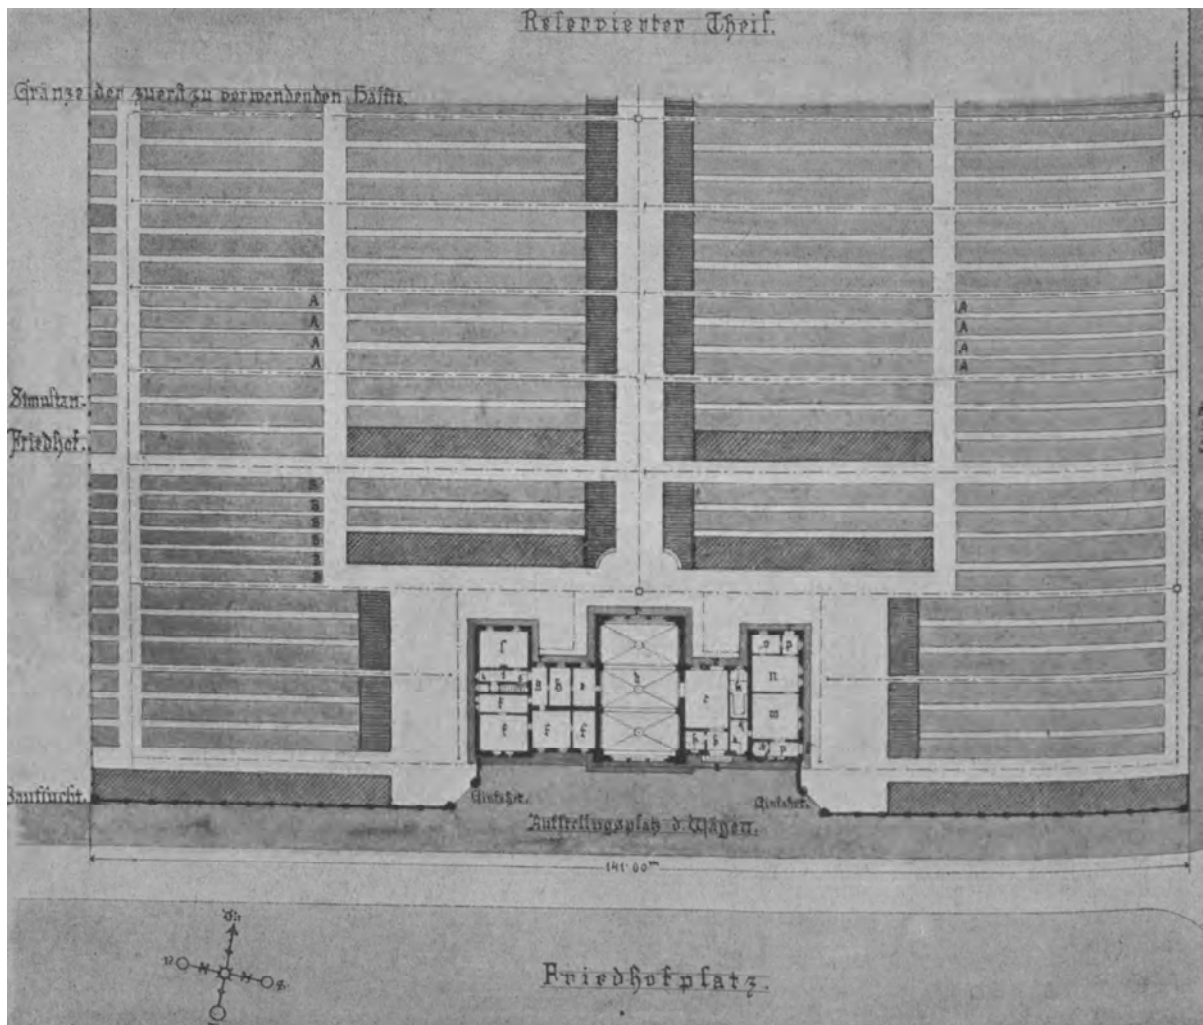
Grundriss Friedhof Gleiwitz
